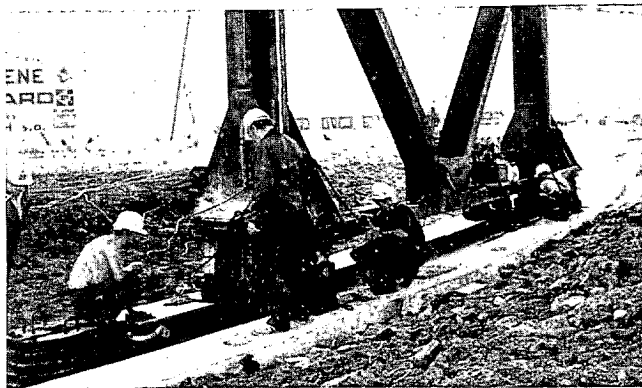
Estructura metálica estabilizadora que gira con el tablero.
